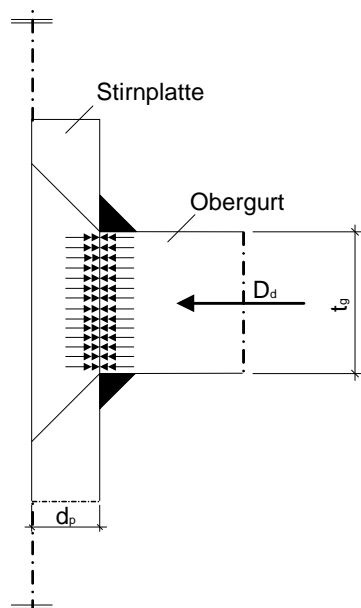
Seitenansicht der Kontaktfläche Trägerflansch-Stirnplatte
